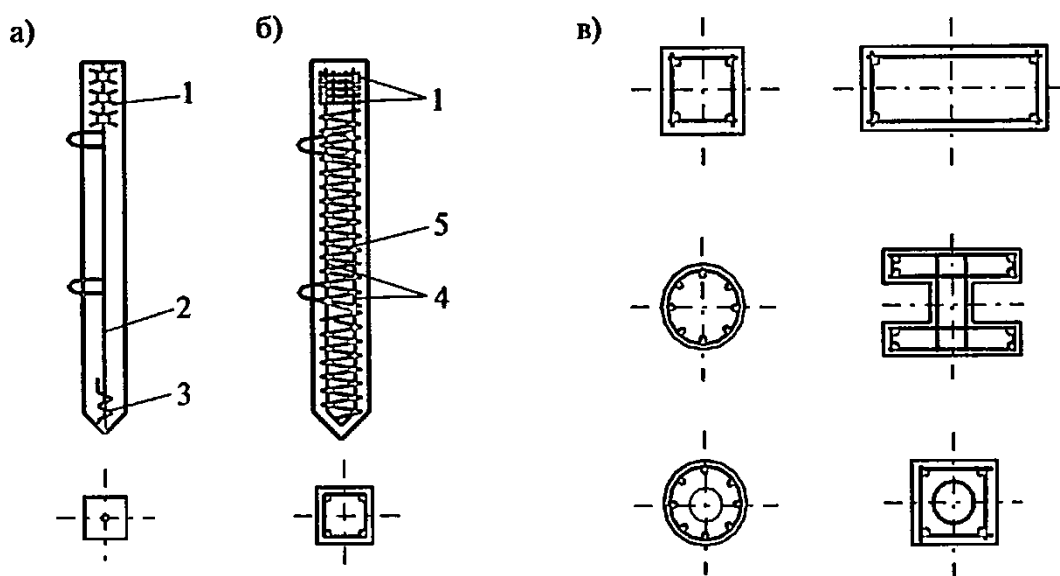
Армирование свай; формы поперечного сечения свай:
